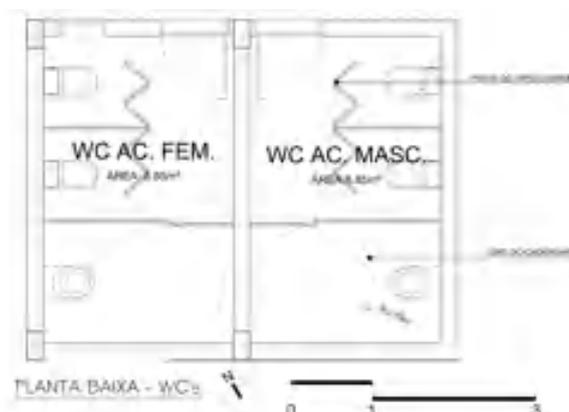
Detalhe da planta baixa dos banheiros acessíveis.
